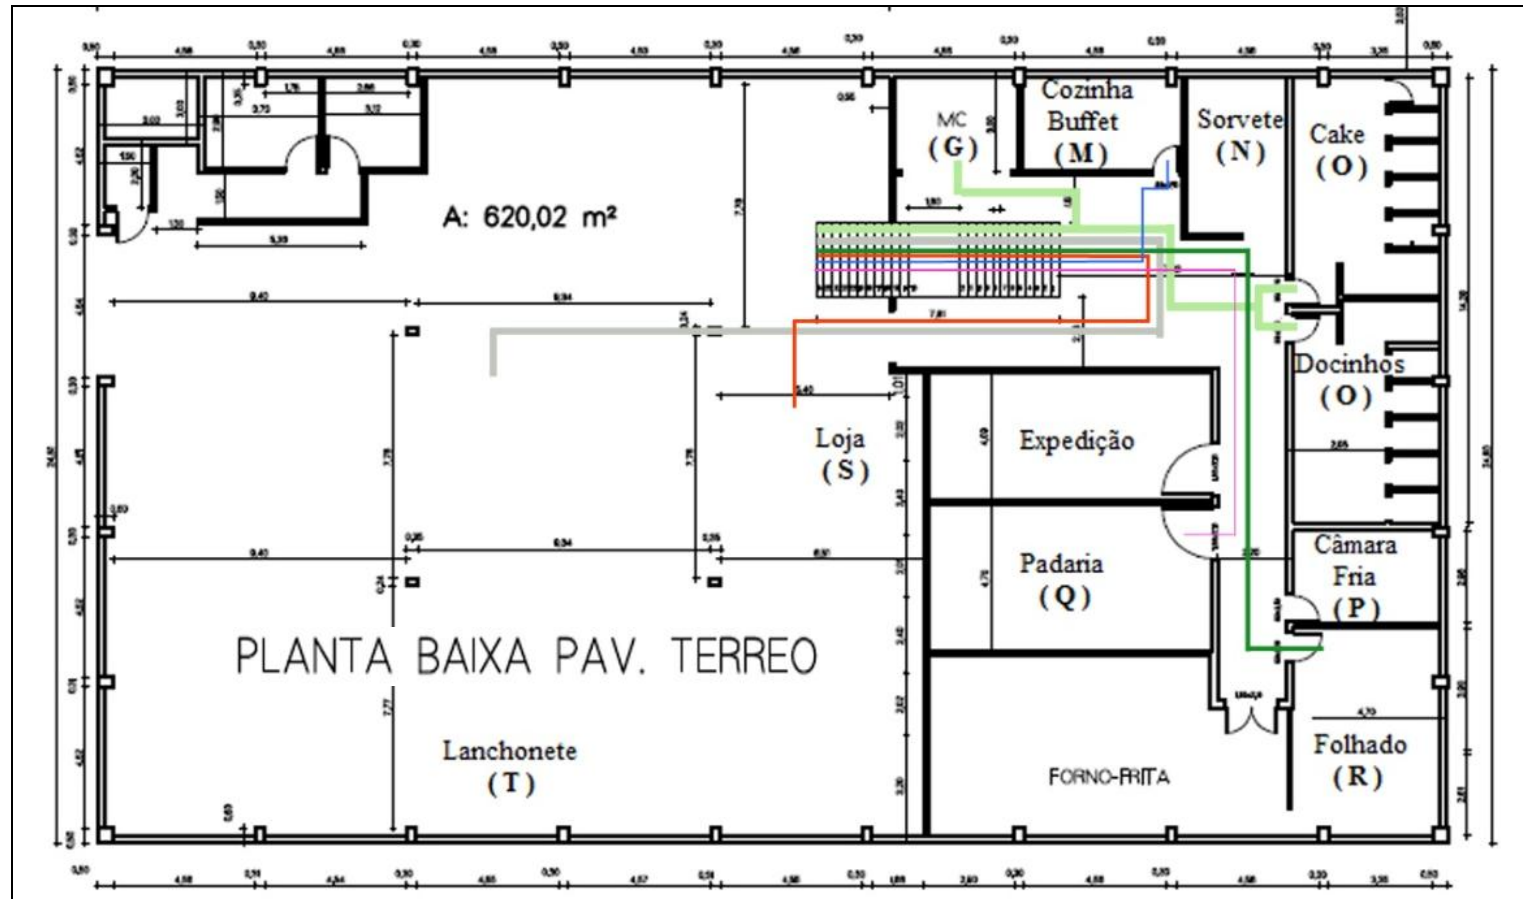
Diagrama Spaghetti planta baixa pavimento térreo
